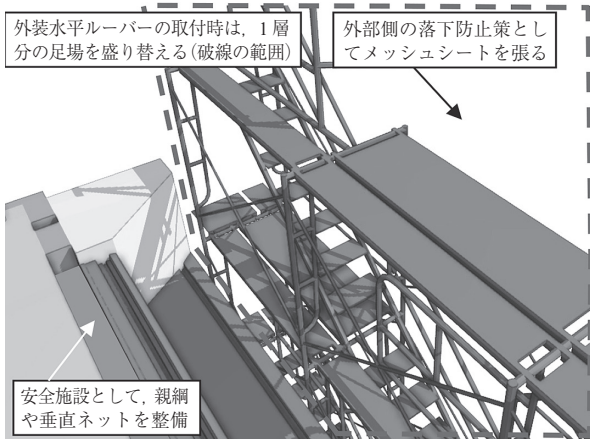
外装水平ルーバー端部の施工検討 (BIM)
